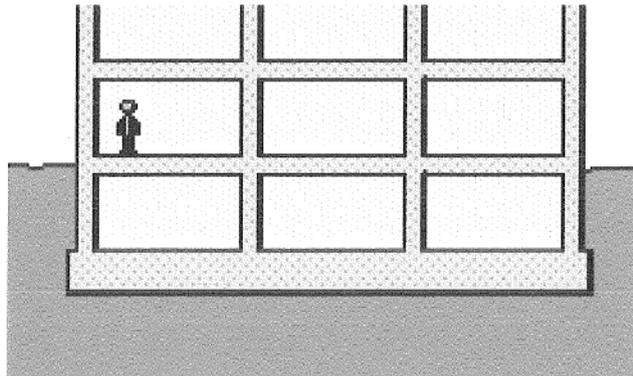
FOTOS: ARQ C. S. GUZZETTI- FUNDACIONES SUPERFICIALES- ZAPATAS CORRIDAS O PLANTILLAS
